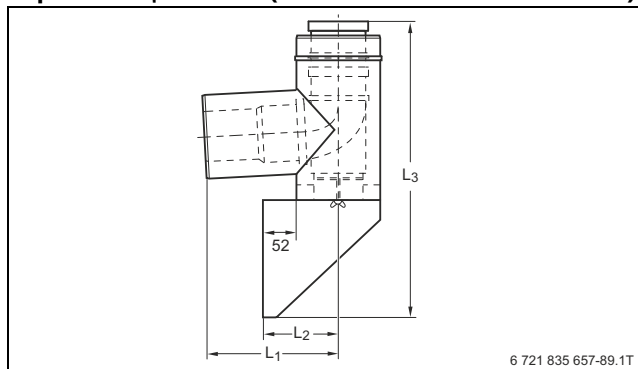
Концентрический тройник приточного воздуха (габариты → Табл. 90)
